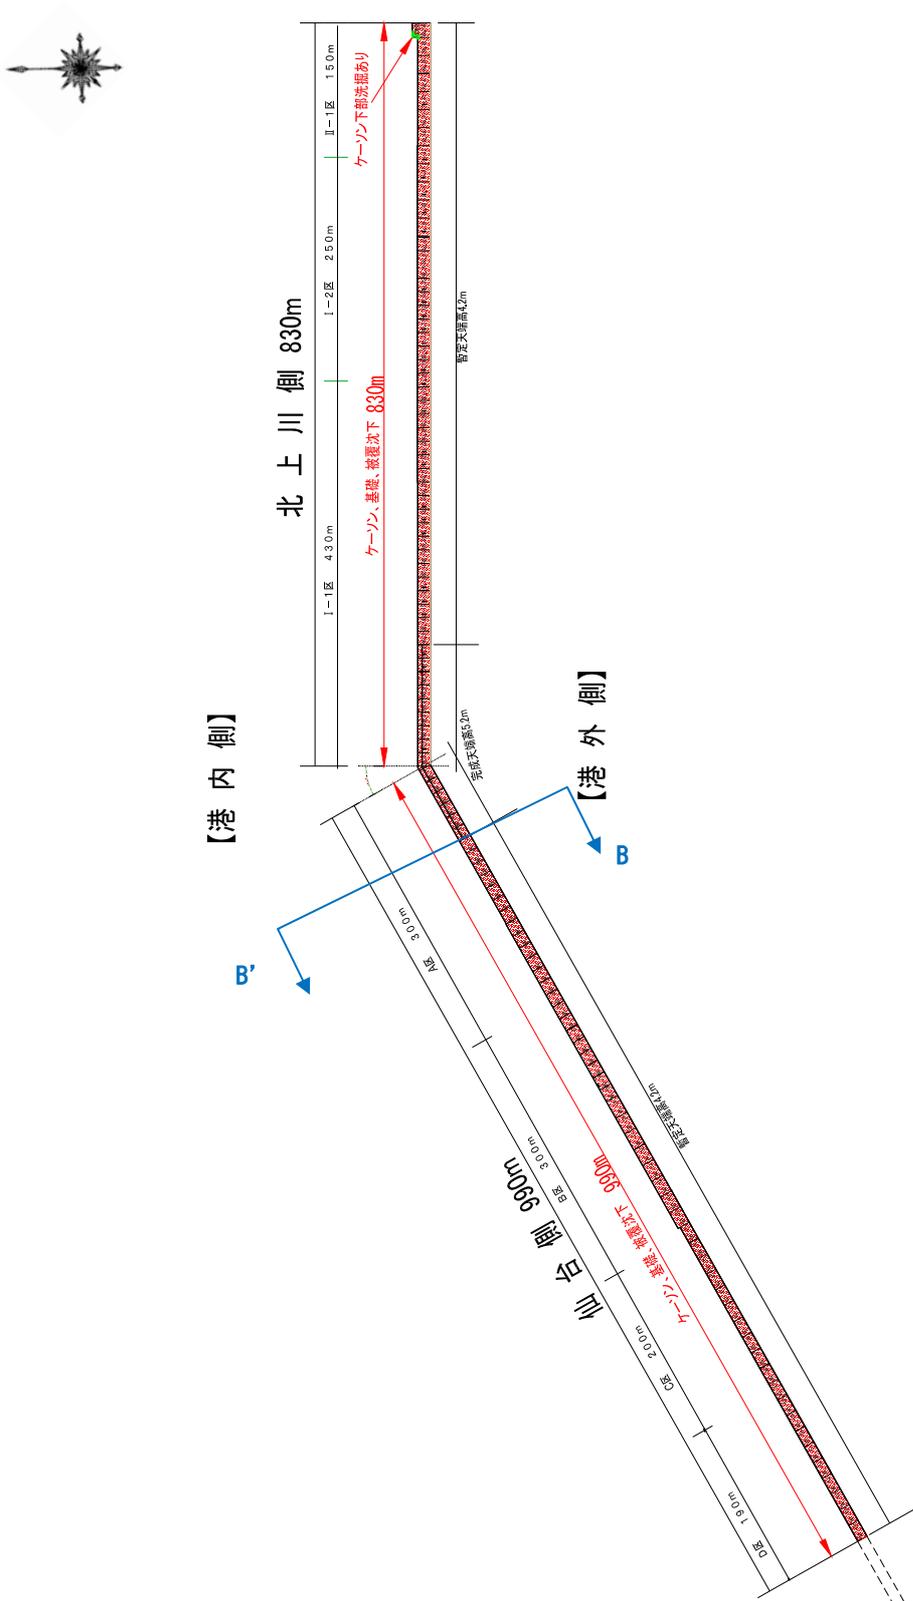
No.1 雲雀野地区 南防波堤の平面図 (復旧後)
